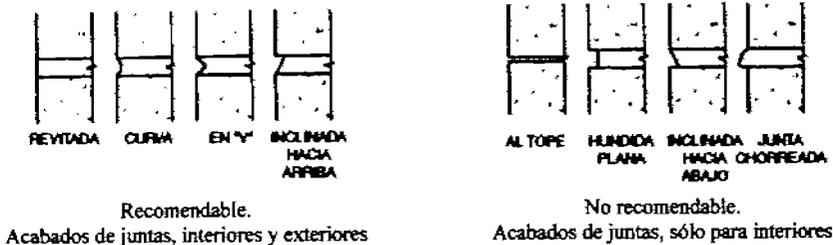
ACABADO DE LAS JUNTAS DE MORTERO
